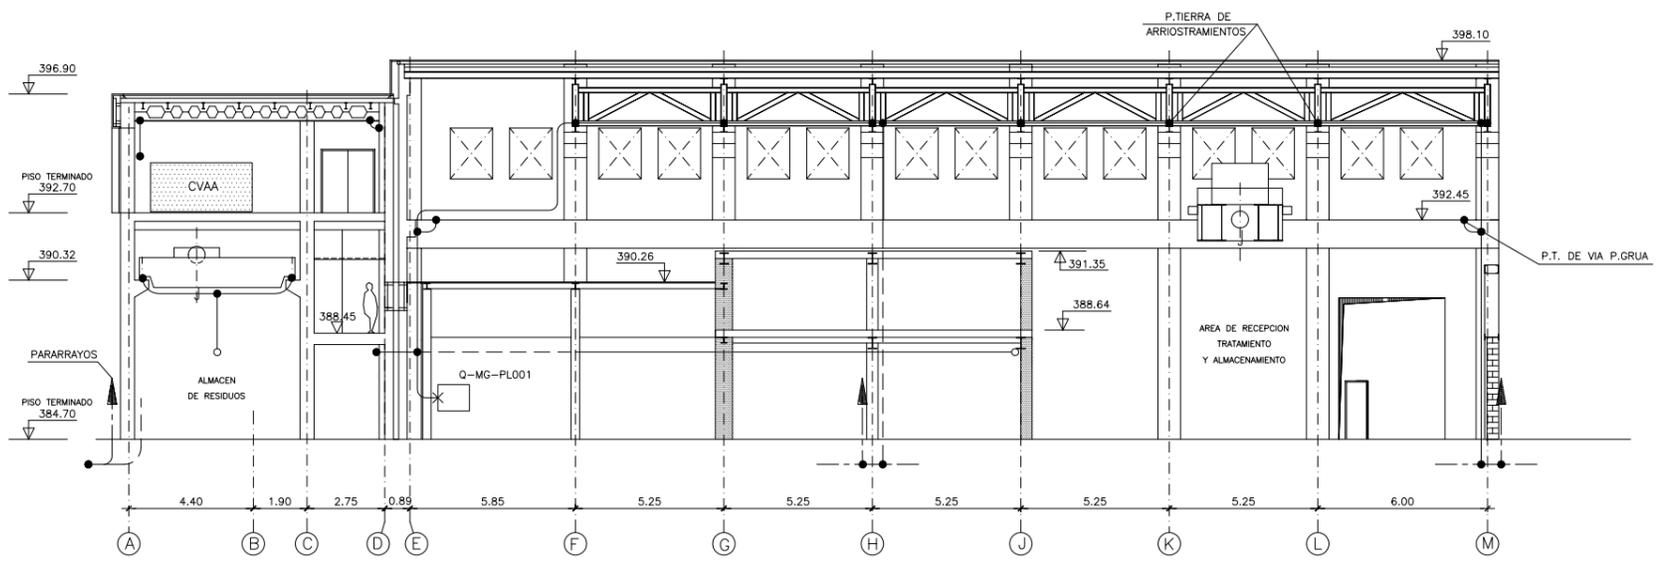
PLANO DE DISPOSICIÓN PLANTA - RMTA - S. FILTROS LABORATORIO.
